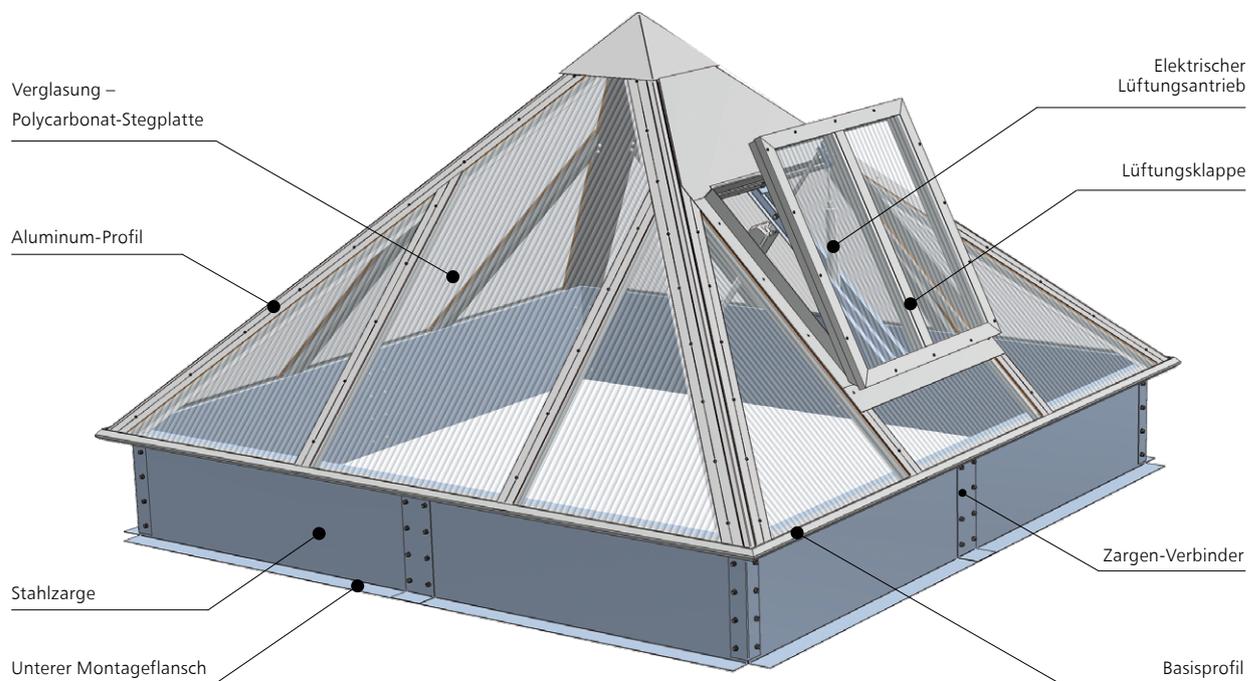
Aufbau eines pyramidenförmigen Oberlichts Typ mcr PROLIGHT mit eingebauter Lüftungsklappe ausgestattet mit einem elektrischen Lüftungsantrieb
